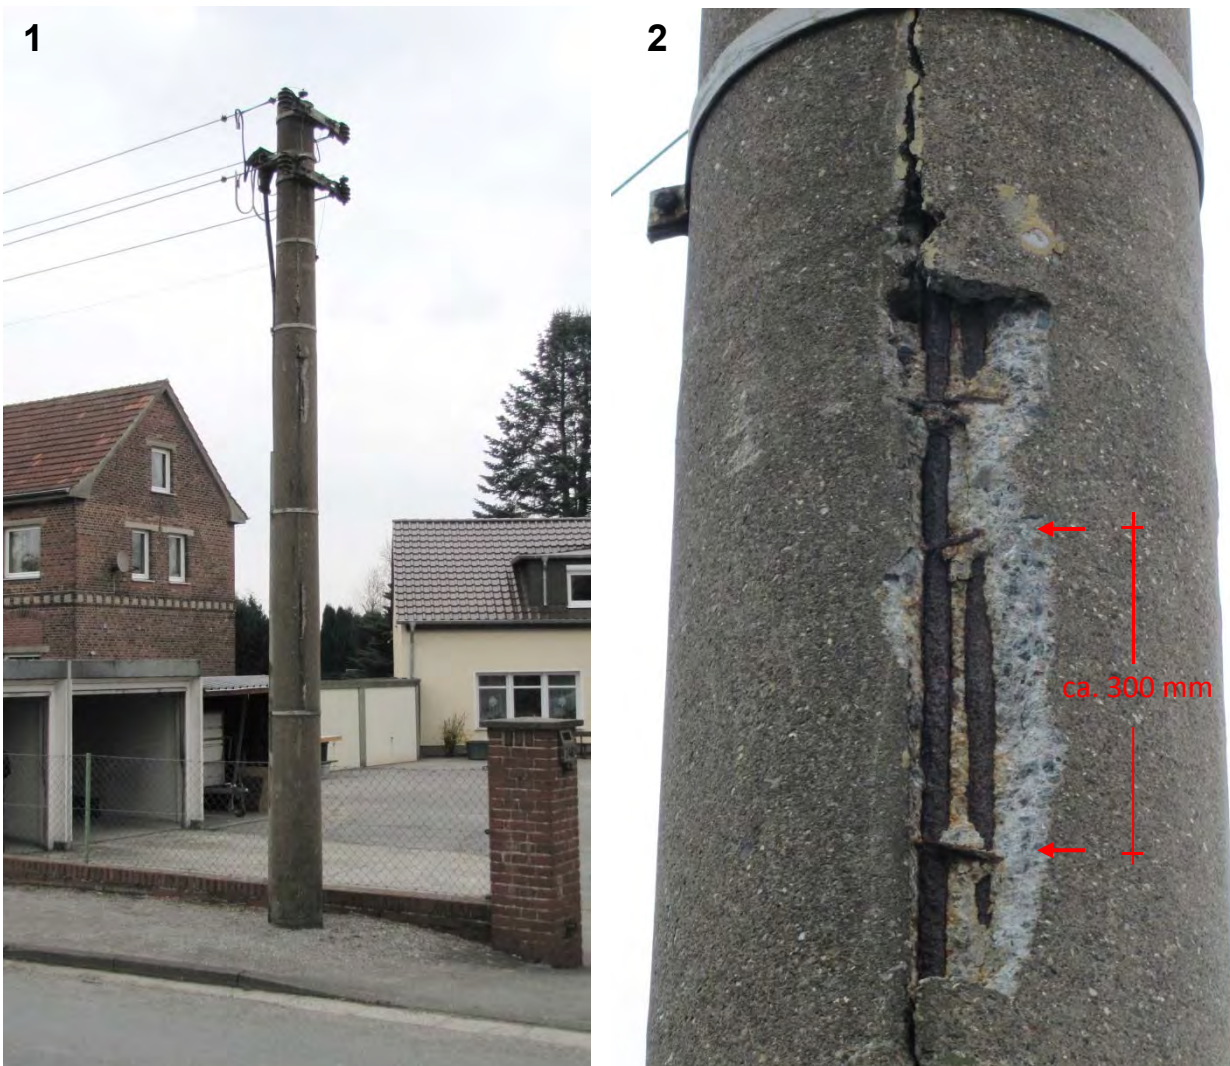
Breiter Vertikalriss und Betonausbruch an der Schalungsfuge eines alten Freileitungsmastes
